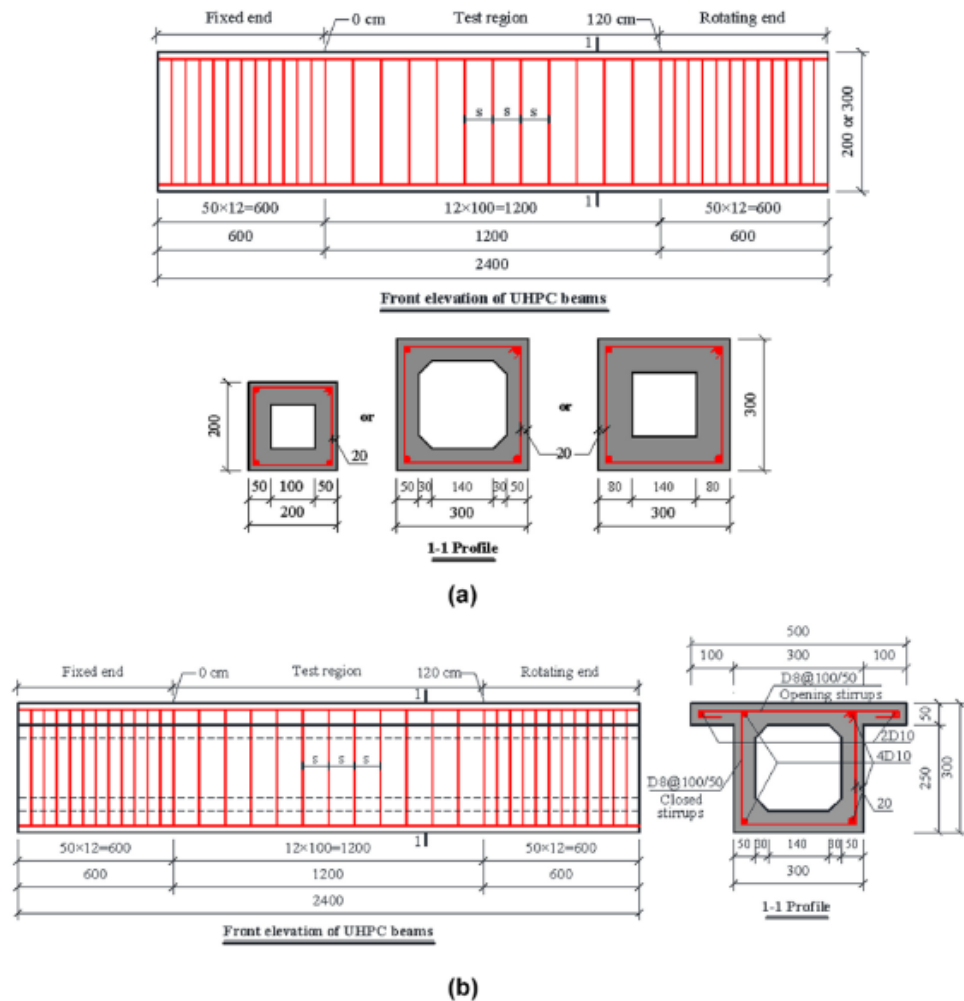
Disposição e dimensionamento da armadura de vigas ocas UHPFRC (mm):
